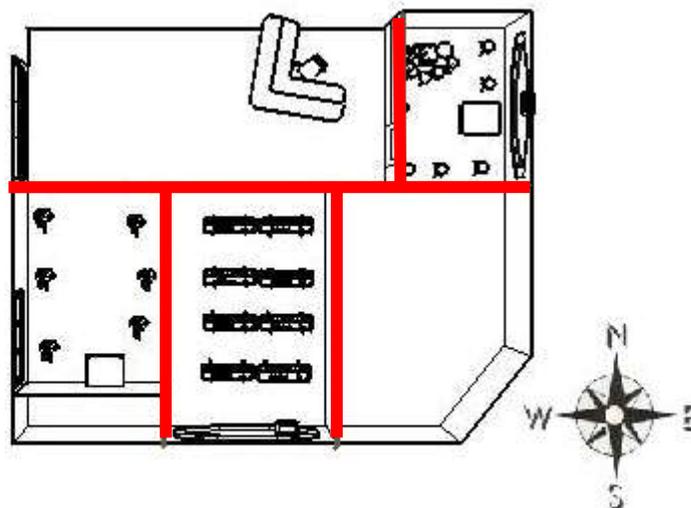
Ubicación de las paredes de madera conectadas entre sí.
